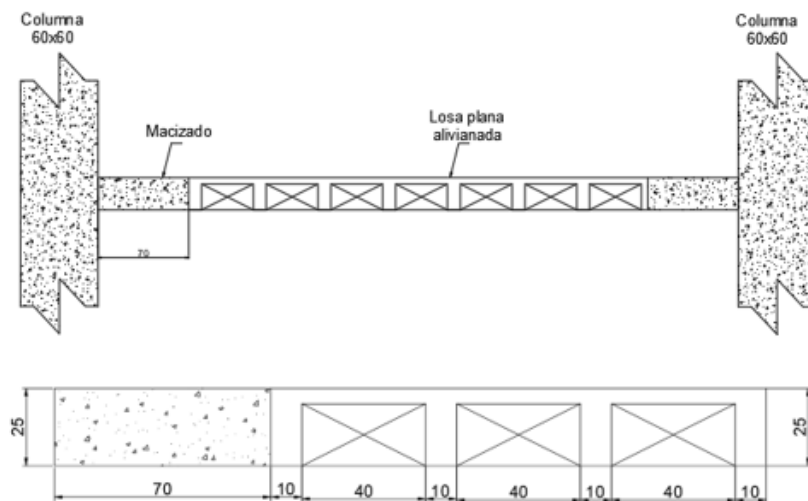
Detalle de Losa plana desde la 1era Planta hasta la 8va Planta del edificio EERCs
